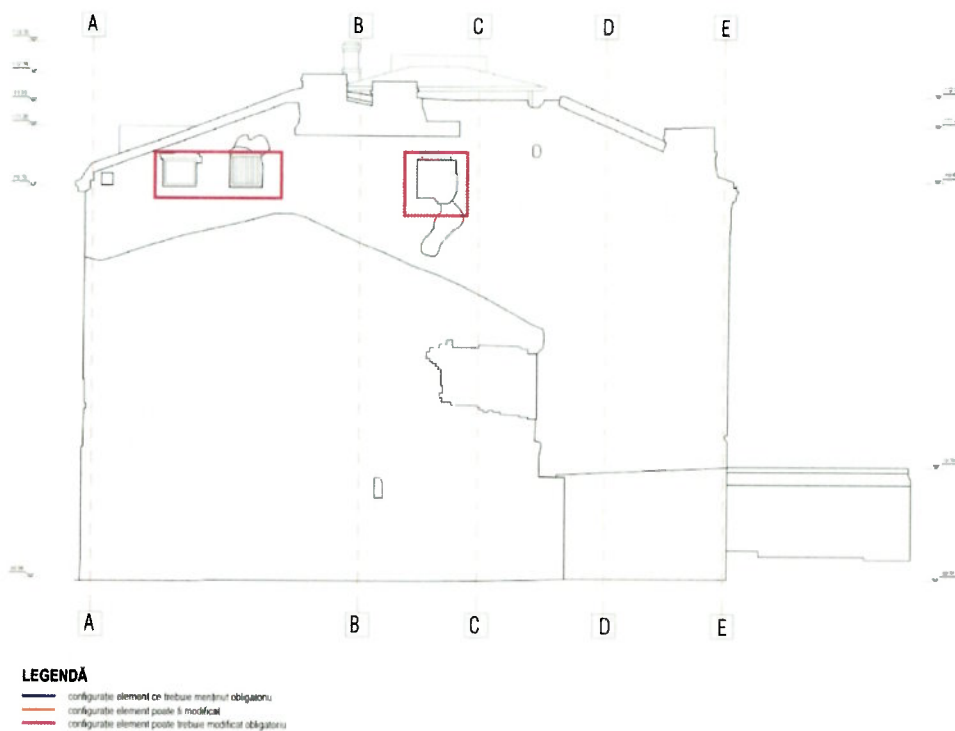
Fațadă laterală dreapta (est, sud-est) – atitudini față de elementele construcției
